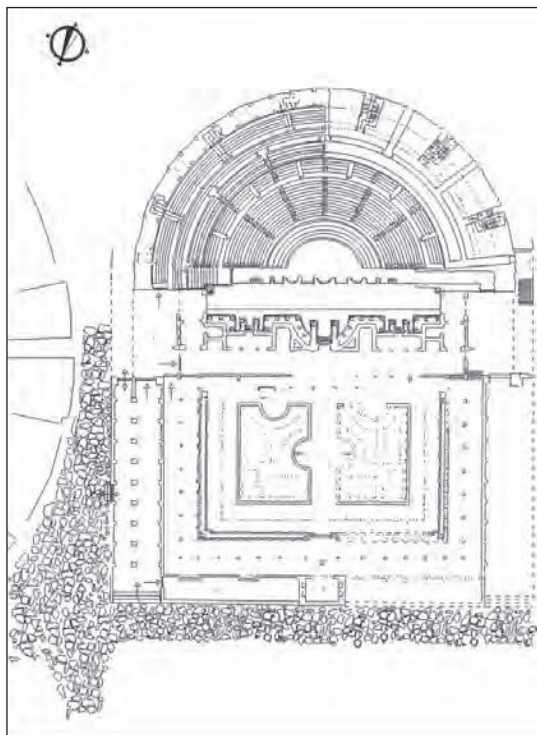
Planimetría del teatro con la representación de los pórticos exteriores al peristilo (elaboración de J. Márquez y P. Mateos sobre planta de R. Durán).
